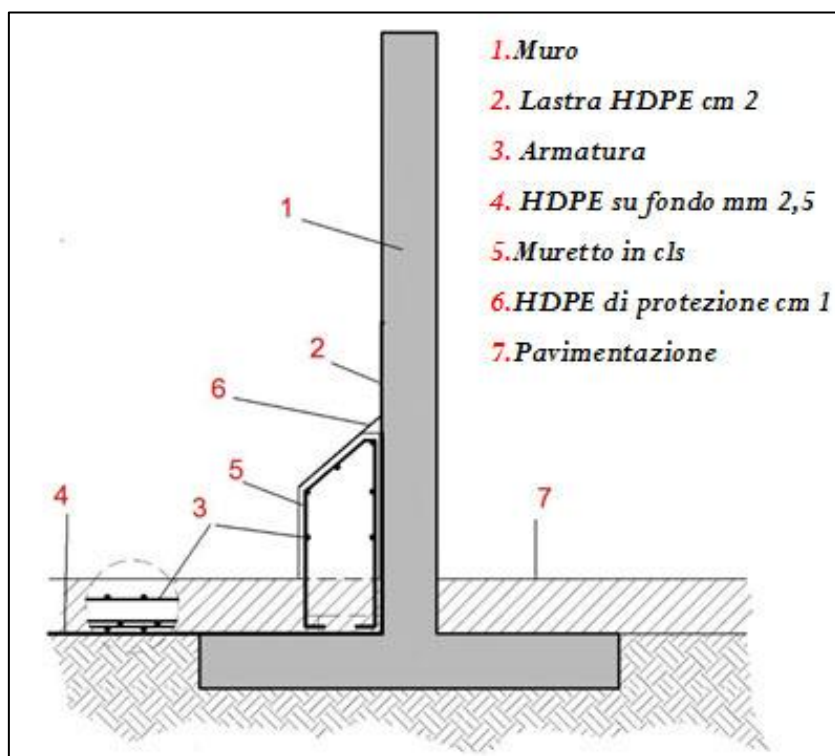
Schema dell'impermeabilizzazione della pavimentazione industriale
